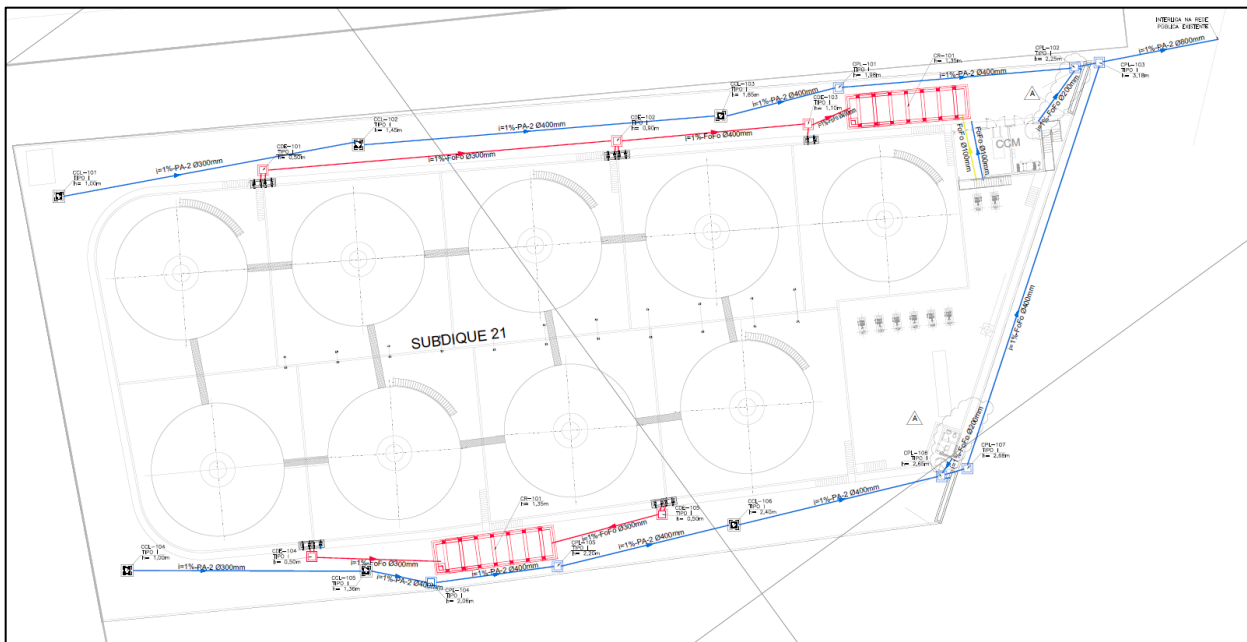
PLANTA DE DRENAGEM – TERMINAL 2
